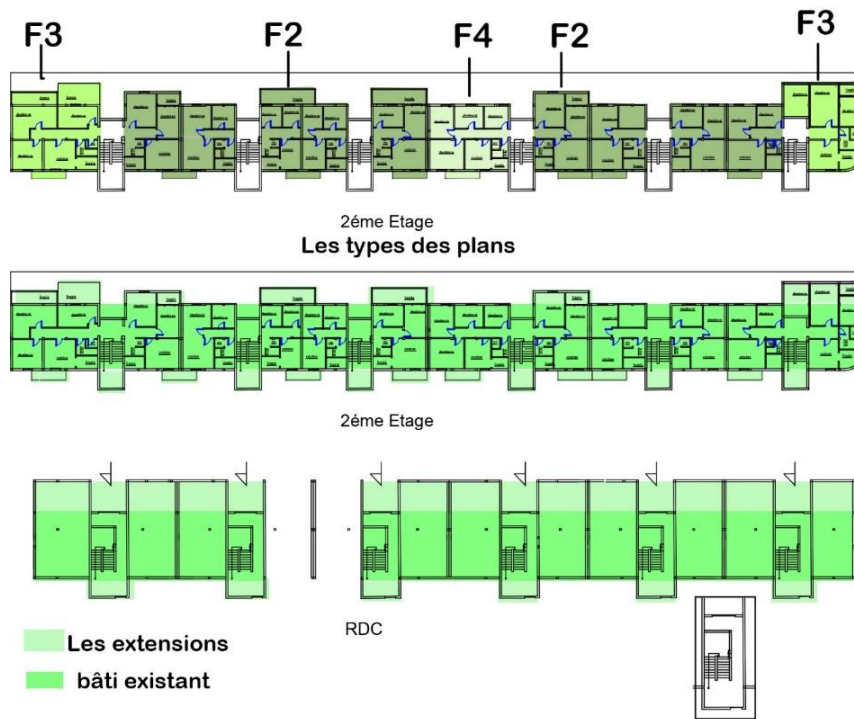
Les plans intérieur de bâti n°2 , traité par l'auteur
